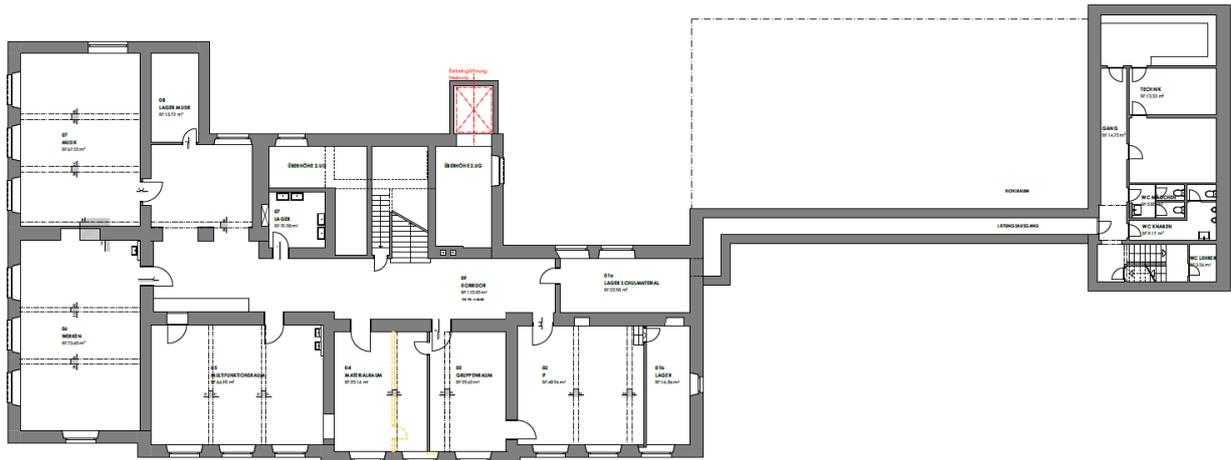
; Grundriss Untergeschoss Haupttrakt (1. Teilsanierung)
